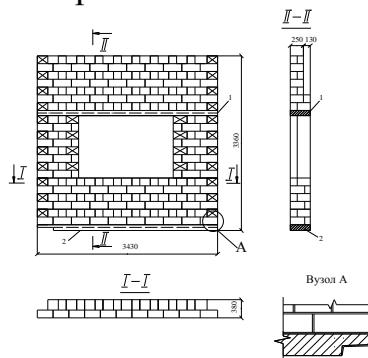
Стінова панель із керамічних каменів без вертикального армування: 1— залізобетонна перемичка; 2— залізобетонна основа; 3— закладна деталь
